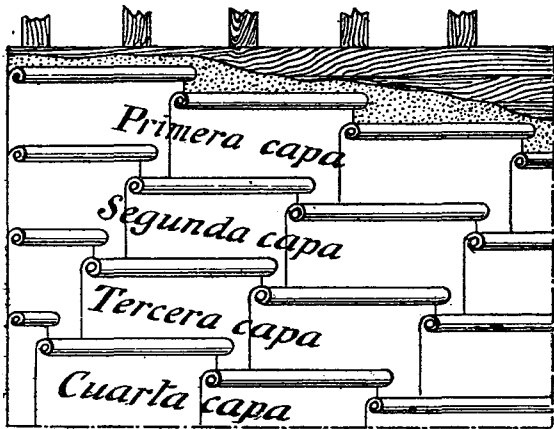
Colocación de las capas de papel en las cubiertas de cemento volcánico.
